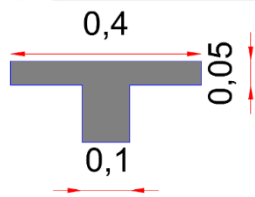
Sección transversal de vigueta típica, (dimensiones en metros)
